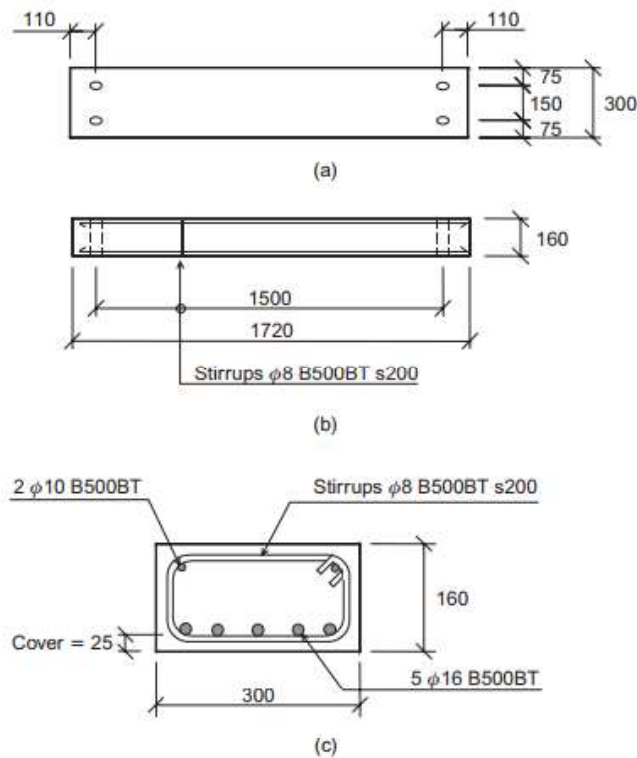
Disposição da viga (a) em planta, (b) alçado, (c) secção transversal.
